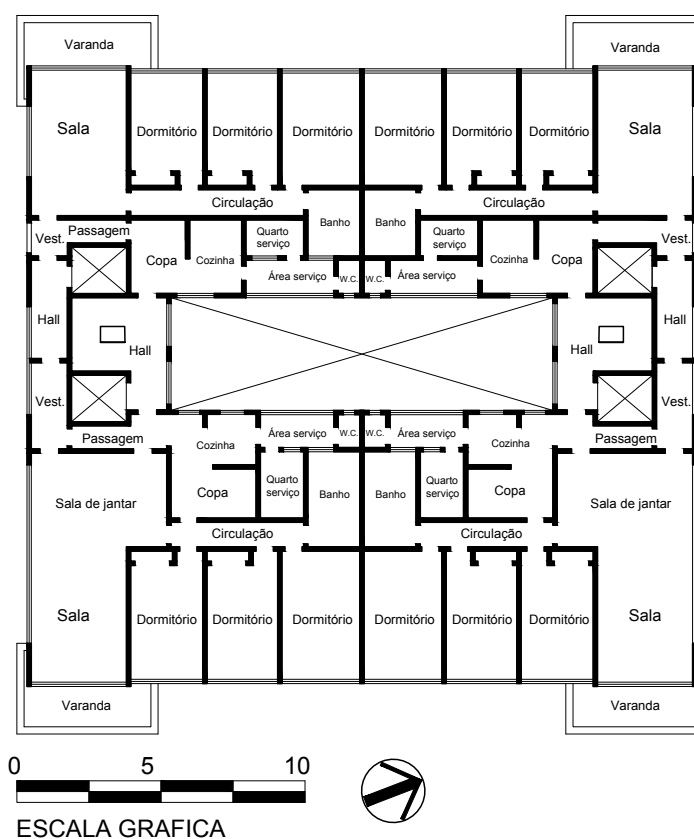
Planta baixa do pavimento tipo – Edifício Parque das Hortênsias
